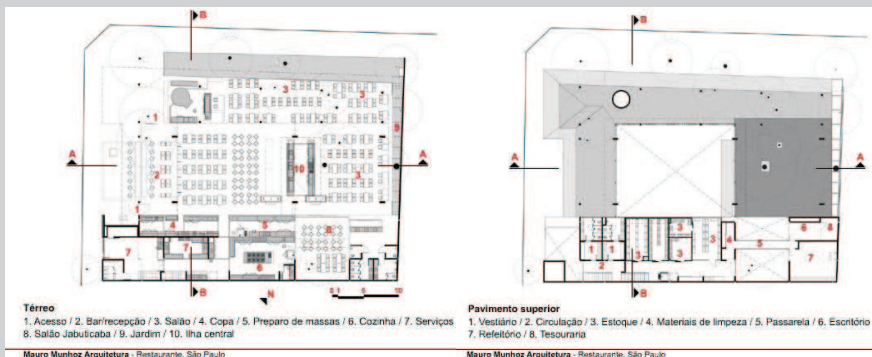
Plantas baixas Restaurante Ráscal, São Paulo
